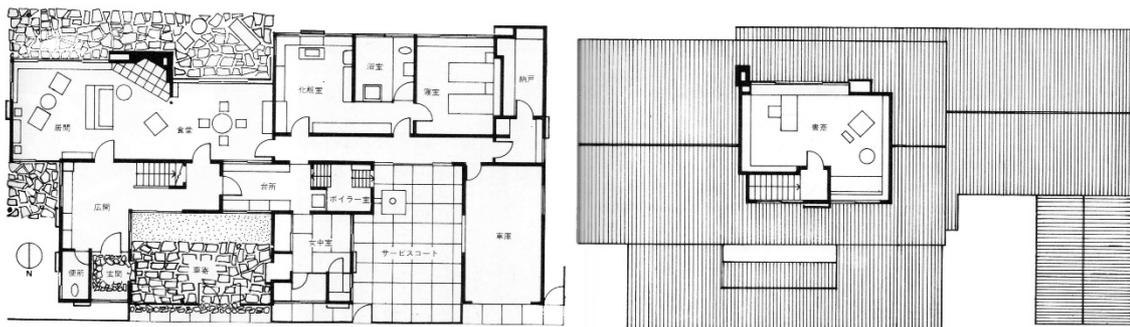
前川國男設計「笠間邸」（1939）平面図（左：1階平面図 右：2階平面図）
